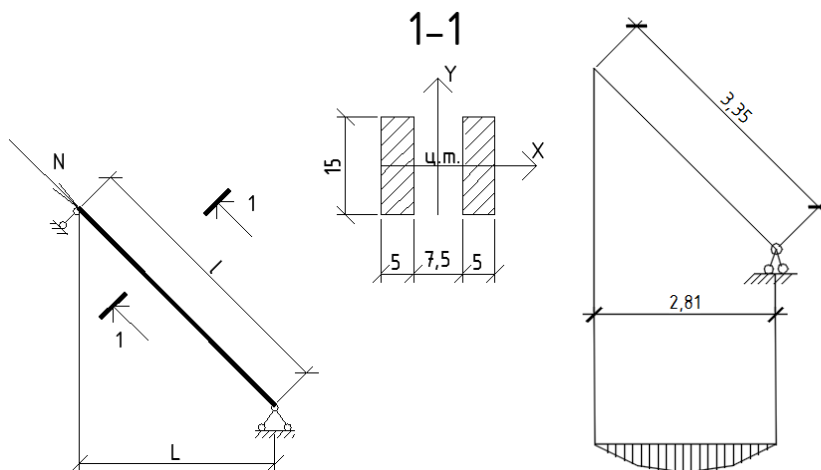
Расчетная схема подкоса стропильной ноги
